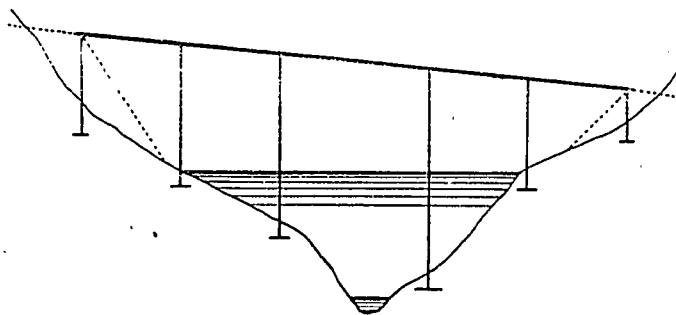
<sup>a</sup>—Una cabeza se hace infinitamente rígida, desaparecen las flexiones  $\phi$  y los pilares se empotran ó se articulan sobre el terreno. Llegamos á los entramados de edificios industriales, pórticos simples ó múltiples, con cubiertas planas, escalonadas ó poligonales.
